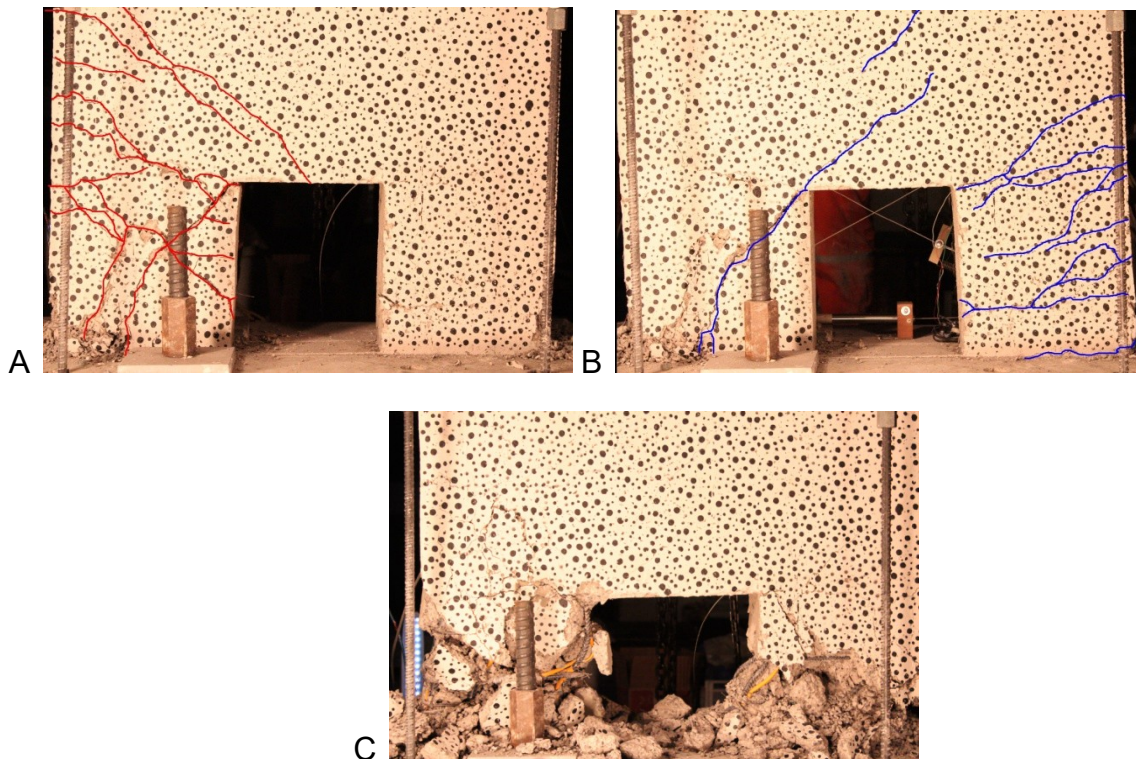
A) Grietas MR1 al 3% dirección positiva. B) Grietas MR1 al 3% dirección negativa. C) Estado final de la probeta.
